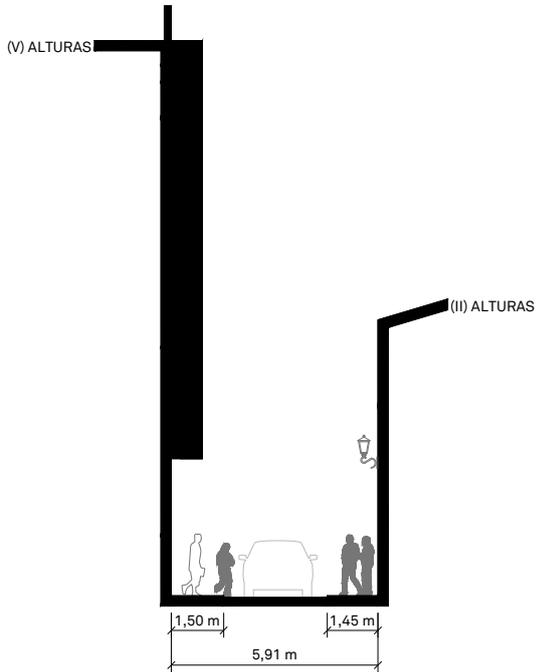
y 102. Calle Benidorm. Elaboración propia.
